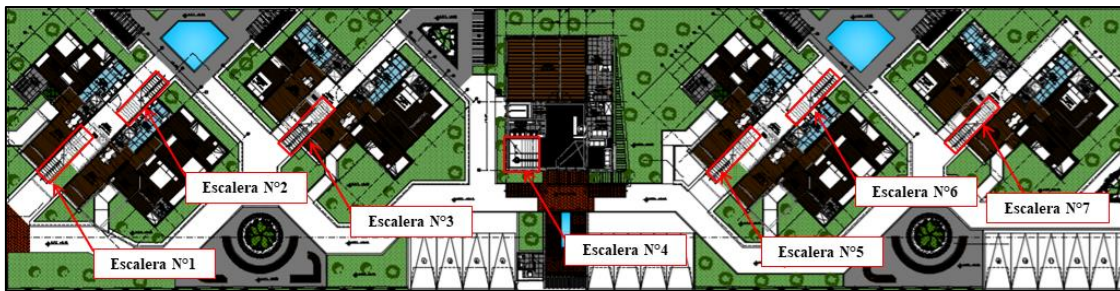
Plano de Ubicación de Escaleras en el 1er piso
